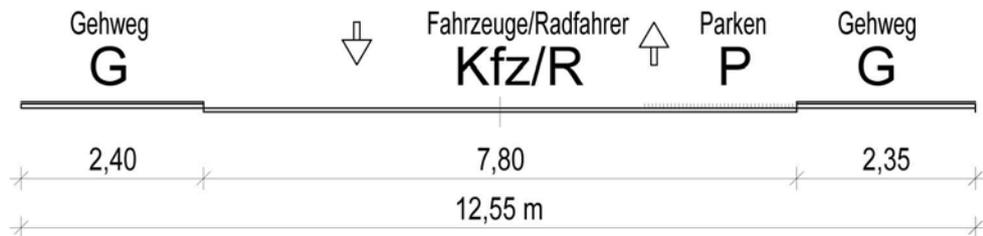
Straßenquerschnitt Dr.-Unruh-Straße (unmaßstäblich, gemäß Vermessung)
